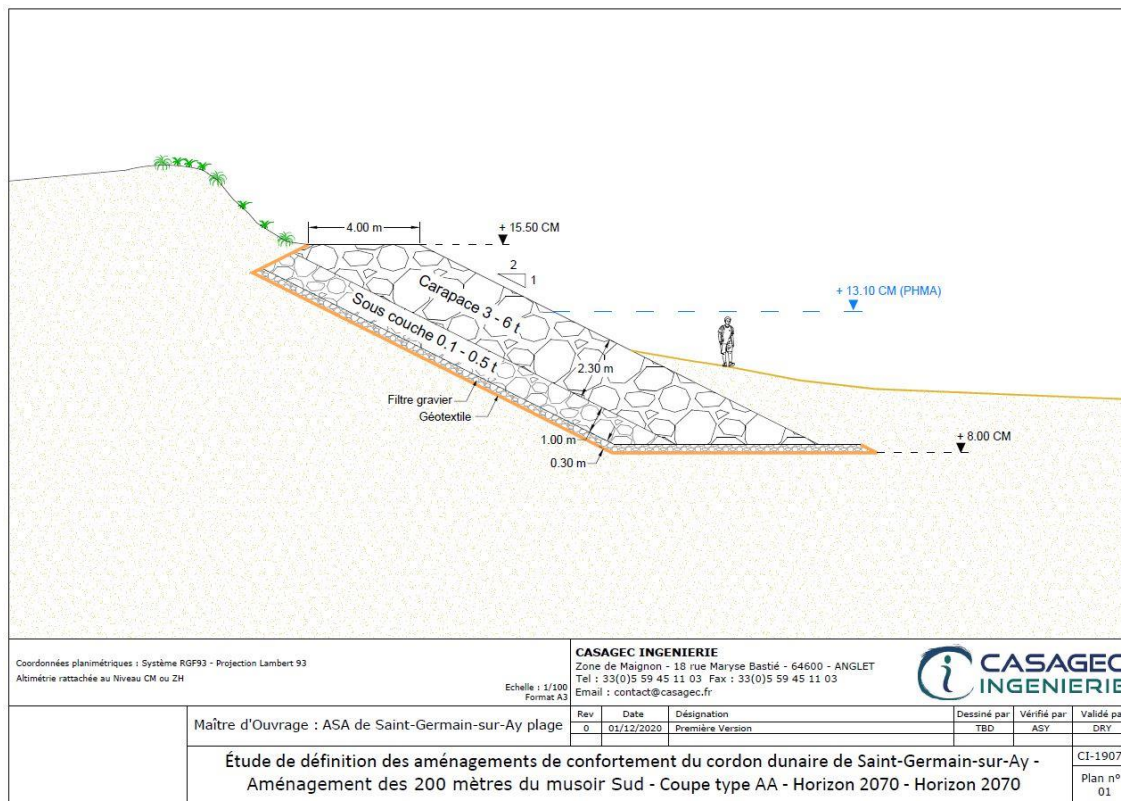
Section-type de l'ouvrage retenu (scénario horizon 2070 : crête à 15,5 m CM et carapace constituée de blocs 3-6t)
